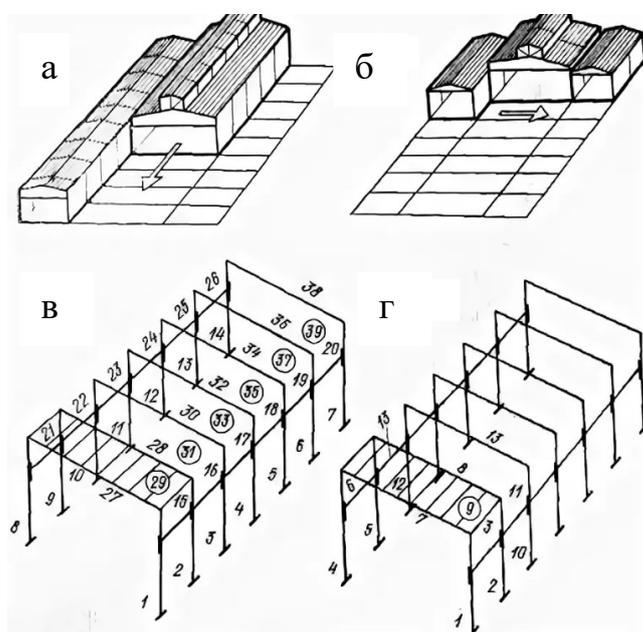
Схемы монтажа конструкций промышленного здания: а) с продольным направлением движения монтажного крана; б) с поперечным направлением движения монтажного крана; в) раздельный метод монтажа элементов каркаса; г) комплектный метод монтажа элементов каркаса
